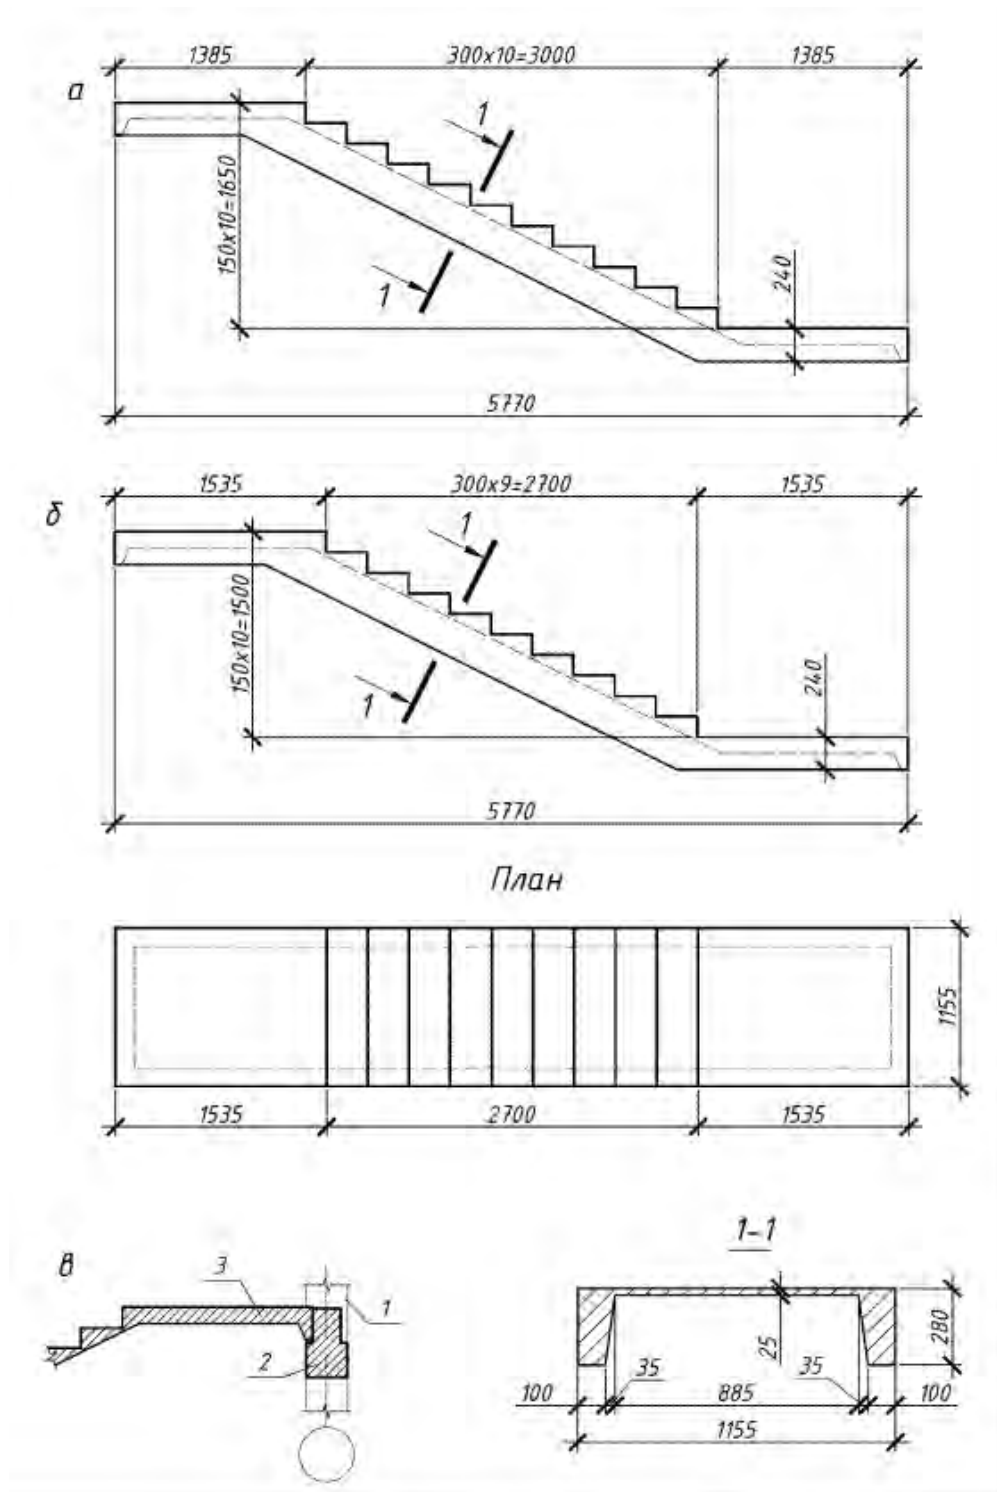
Збірні залізобетонні елементи сходових кліток: а – для будівель із висотою поверхів 3,3 м; б – для підвалів будівель з висотою 2,9 м; в – вузол спирання сходів на ригель; 1 – колона; 2 – ригель довжиною 3,0 м для спирання сходів; 3 – сходи
